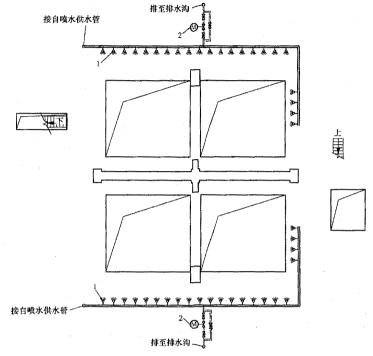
翻车机室水喷雾抑尘系统布置平面图 1—喷嘴; 2—电磁阀
